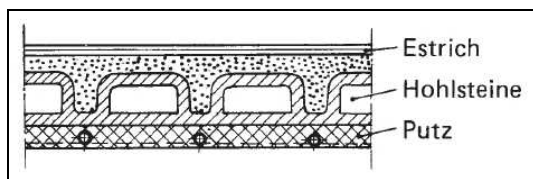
Rohr-Deckenheizung mit Heizrohren im Deckenputz.
